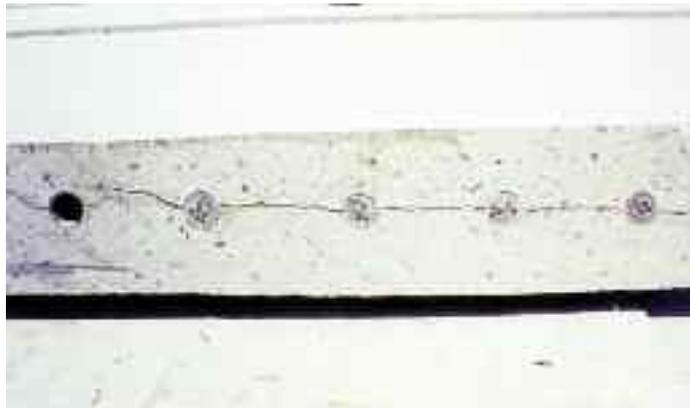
lors du démontage du pont de Nemours, le réancrage des câbles a provoqué le fendage du hourdis (crédit photo Sétra)
